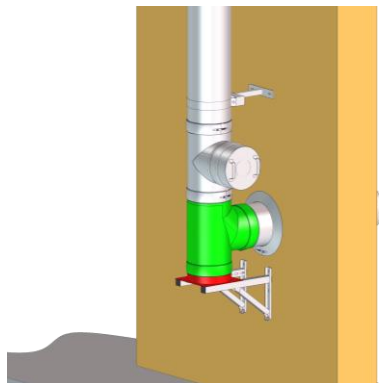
Aufbau mit Grundplatte und Winkel z. B. 90° mit Stützfuß
